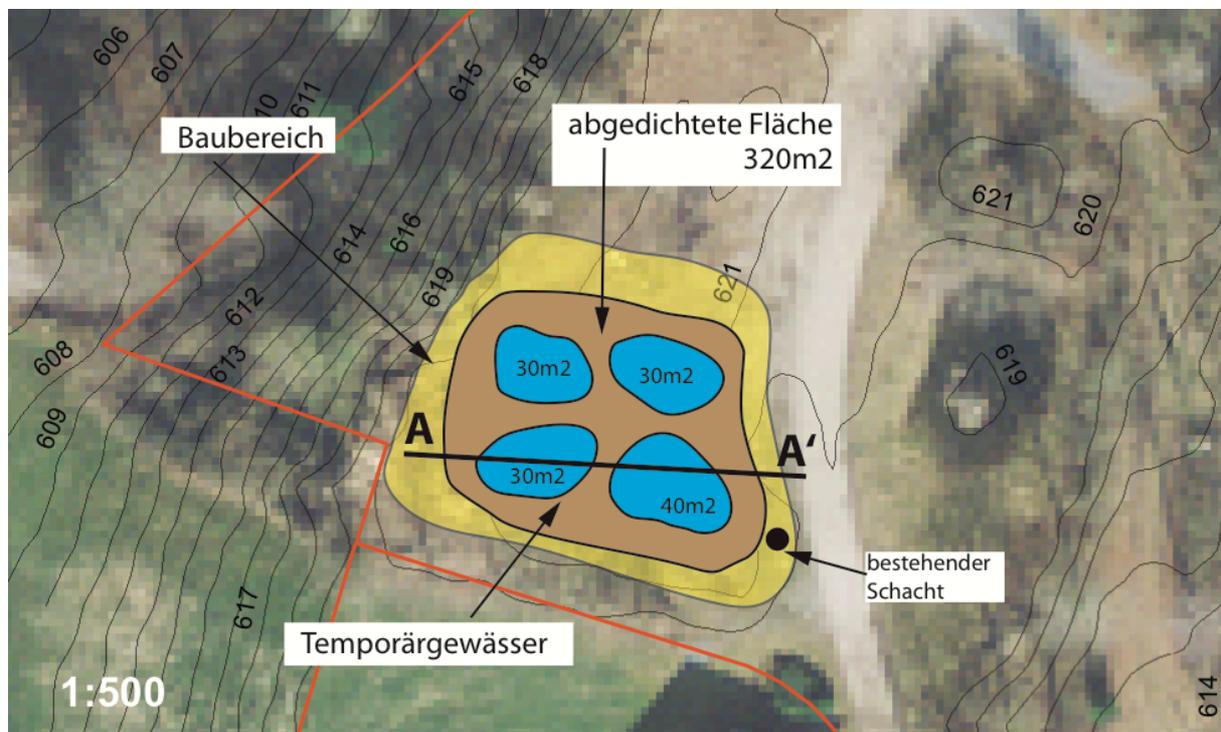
Grundriss von Teilprojekt 1
